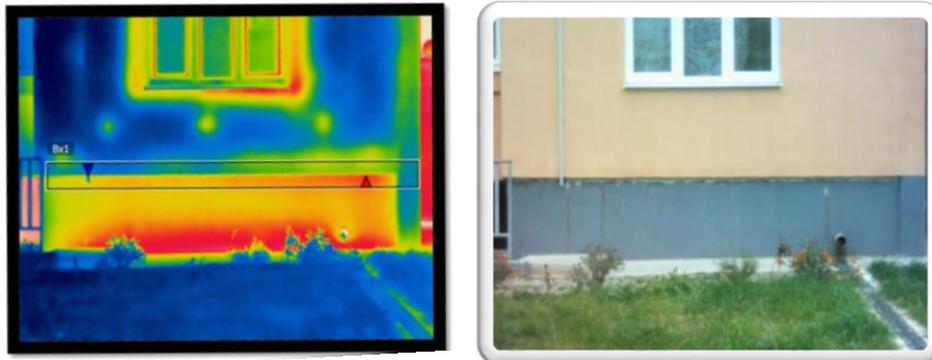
Тепловизионное обследование наружных стен подвала
